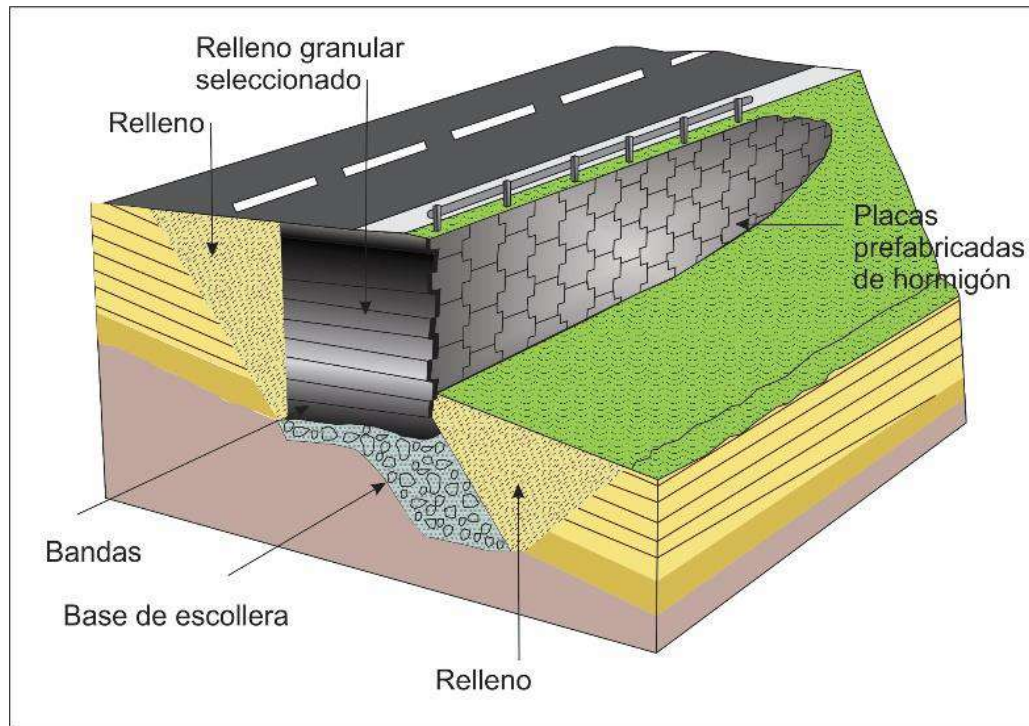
Muro de tierra armada (modificado de Canmet, 1977).
